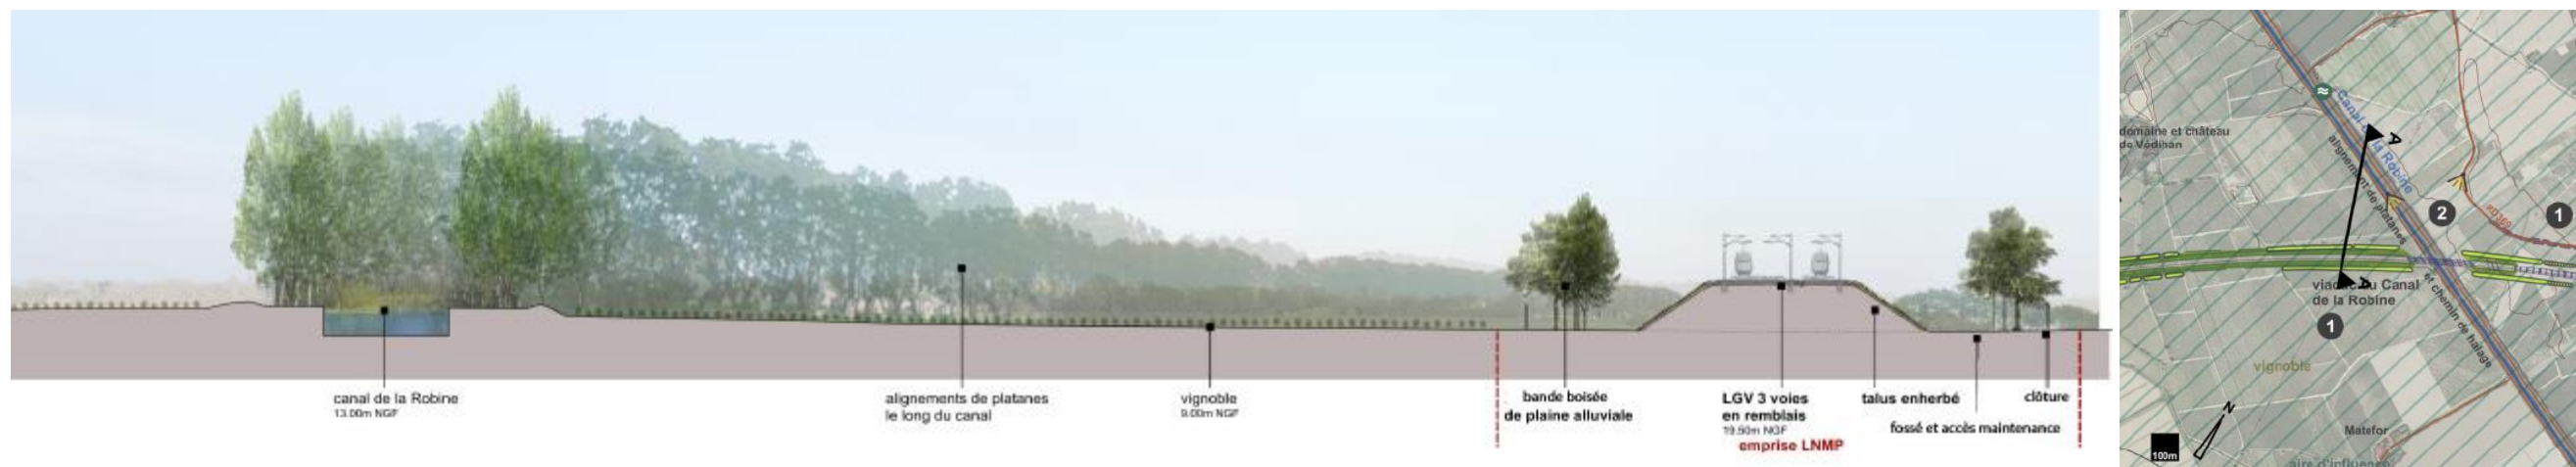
profil en travers du canal de la Robine - Coupe A-A - (source : Traverses)
